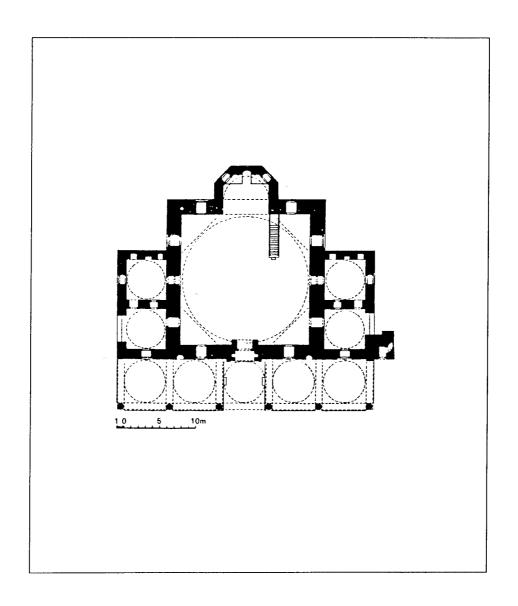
مسقط أفقي لمسجد حاجى شهاب الدين باشا في أدرنة (عن : كوران) .
